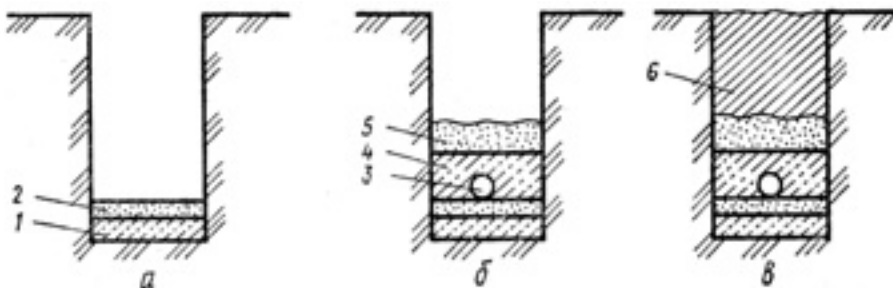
Последовательность устройства дренажа из труб: а – устройство основания; б – укладка труб и засыпка щебня и песка; в – засыпка дрены местным грунтом; 1 – щебень, втрамбованный в грунт слоем 0,1–0,15 м; 2 – песок слоем 0,05 м; 3 – дренажная труба; 4 – фильтр гравийный; 5 – фильтр песчаный; 6 – местный грунт
